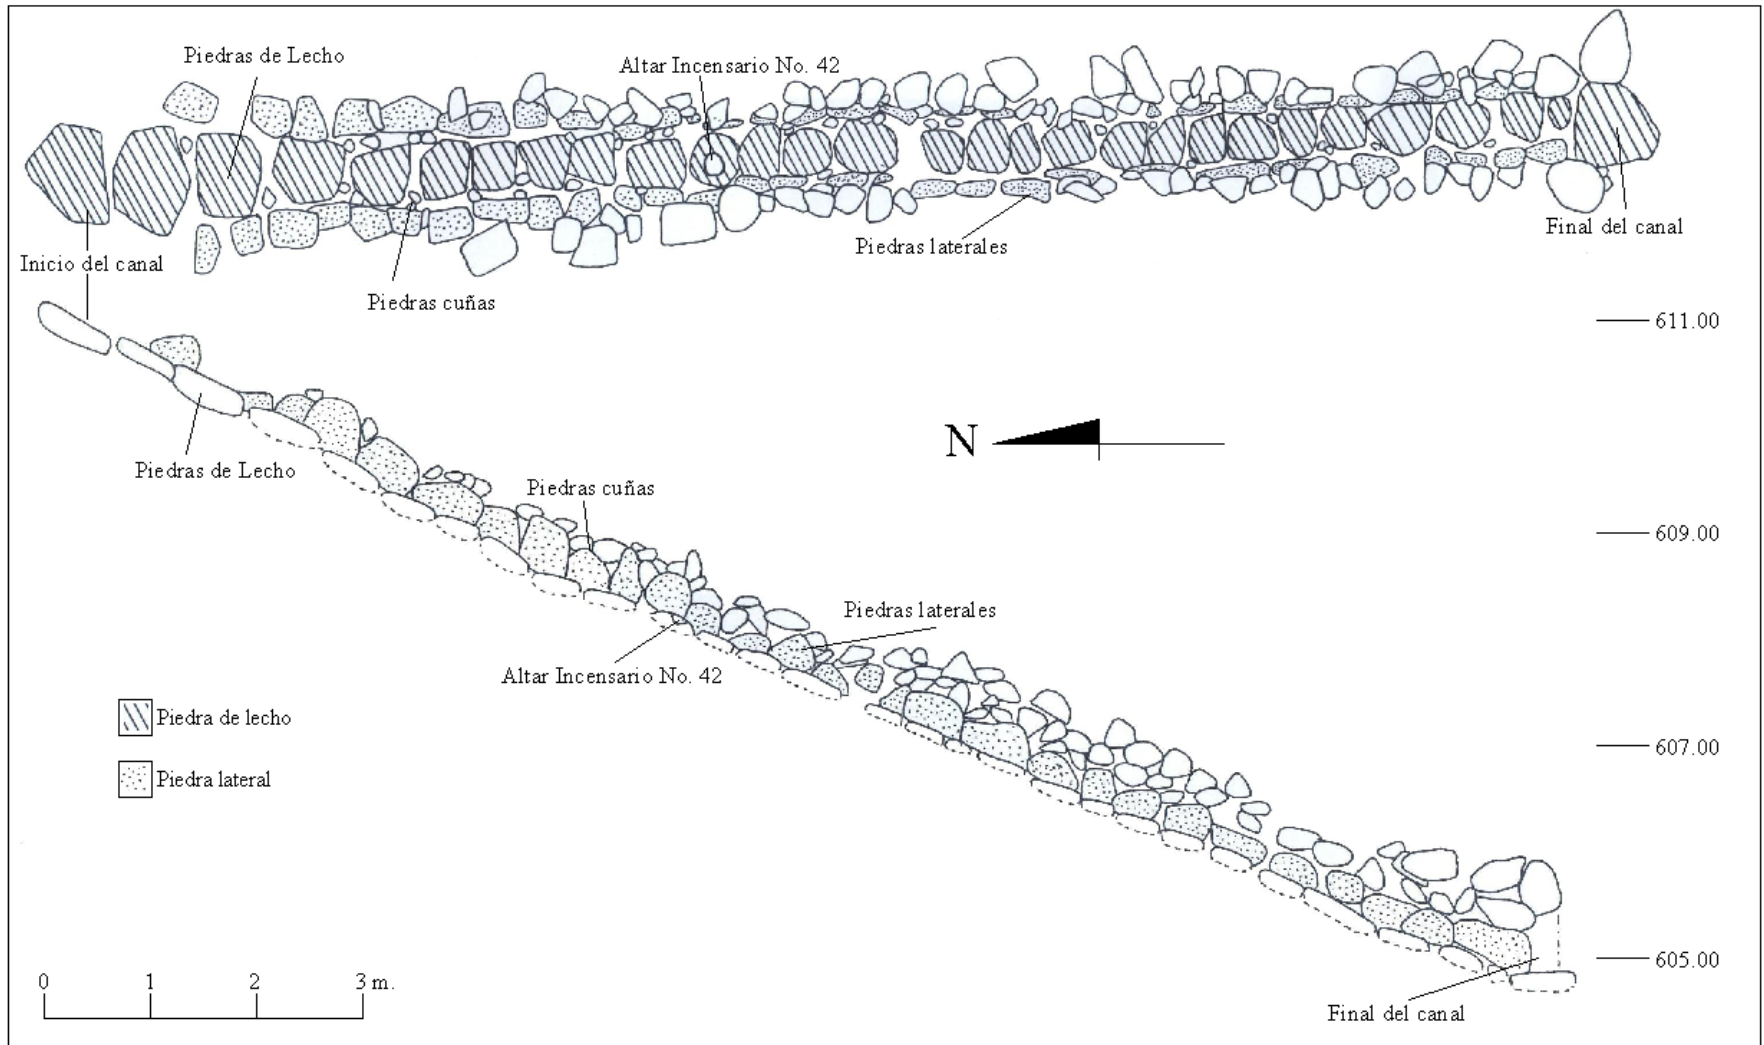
Planta y Perfil este, canal de desagüe “Guacalitos” ubicado en el Acceso a la Terraza No. 3 (Dibujo E. Marroquín 2004).
